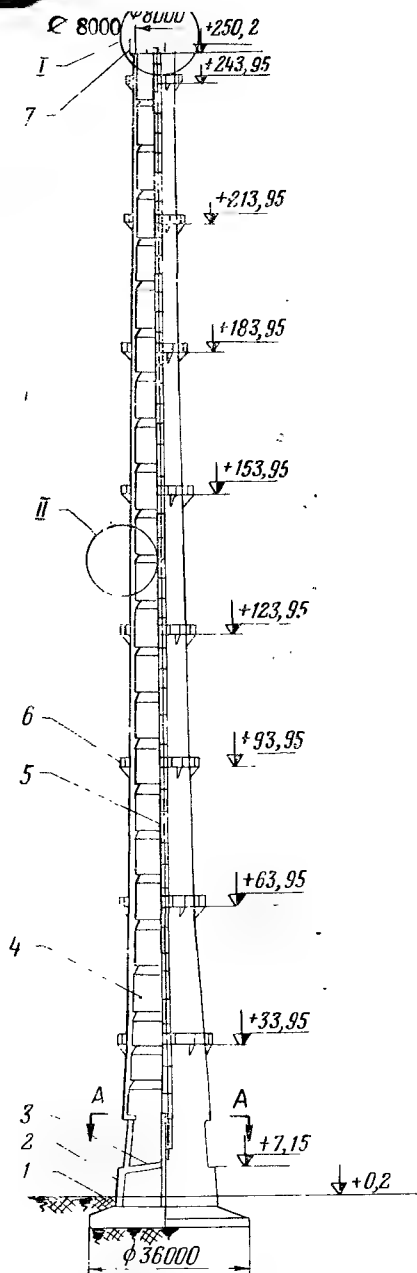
Железобетонная дымовая труба $H=250$ м. 1 — фундамент; 2 — цоколь; 3 — пандус; 4 — ствол; 5 — лодовая лестница; 6 — светофорная площадка; 7 — грозозащита
